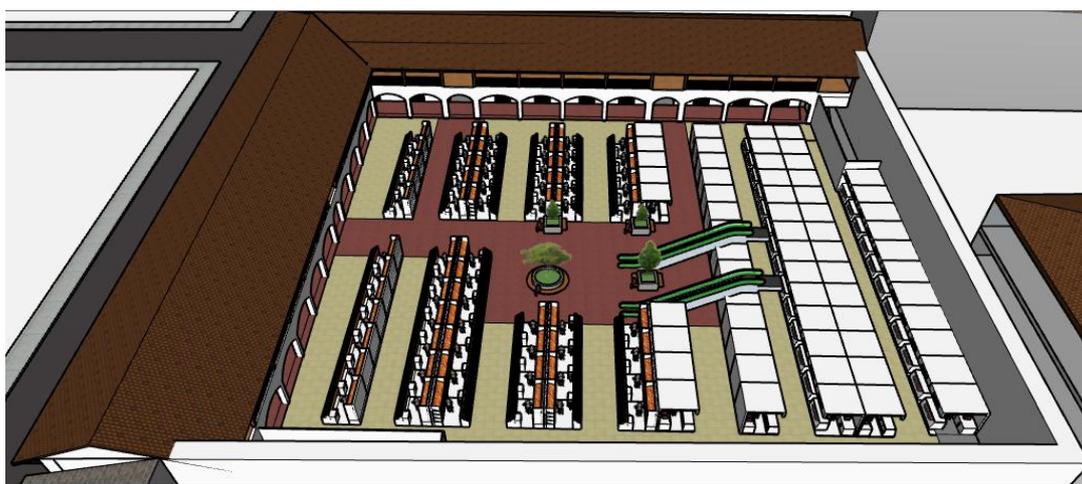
Primera planta de la nueva estructura del Mercado Central de Cajamarca.
